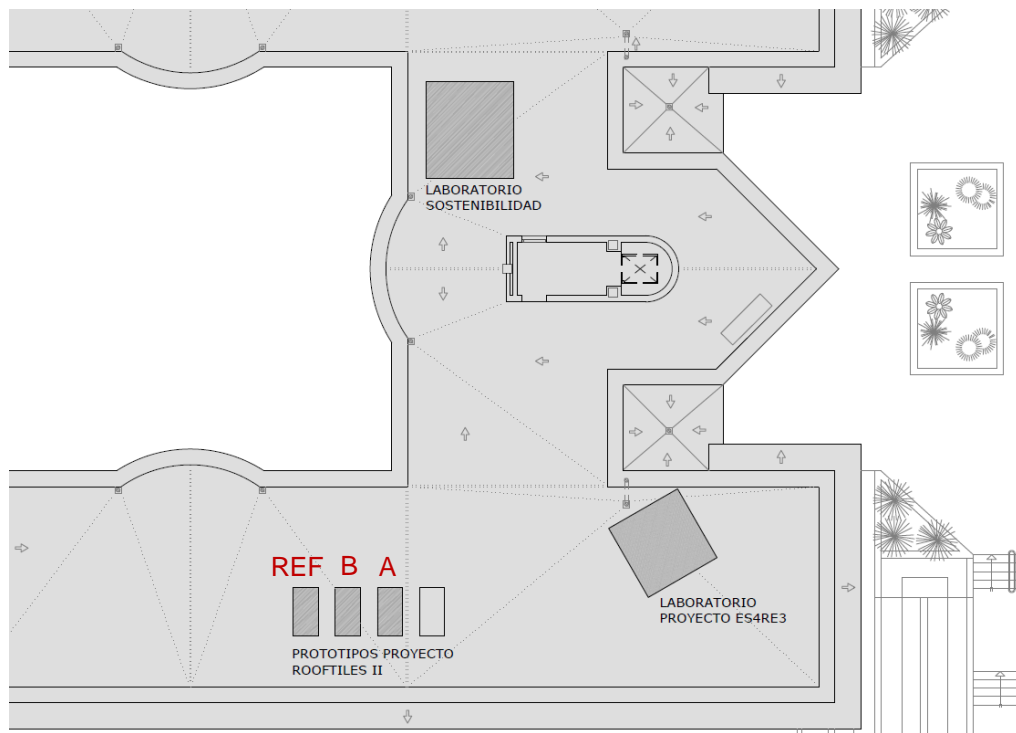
Plano ubicación prototipos en la cubierta del edificio del ITC
